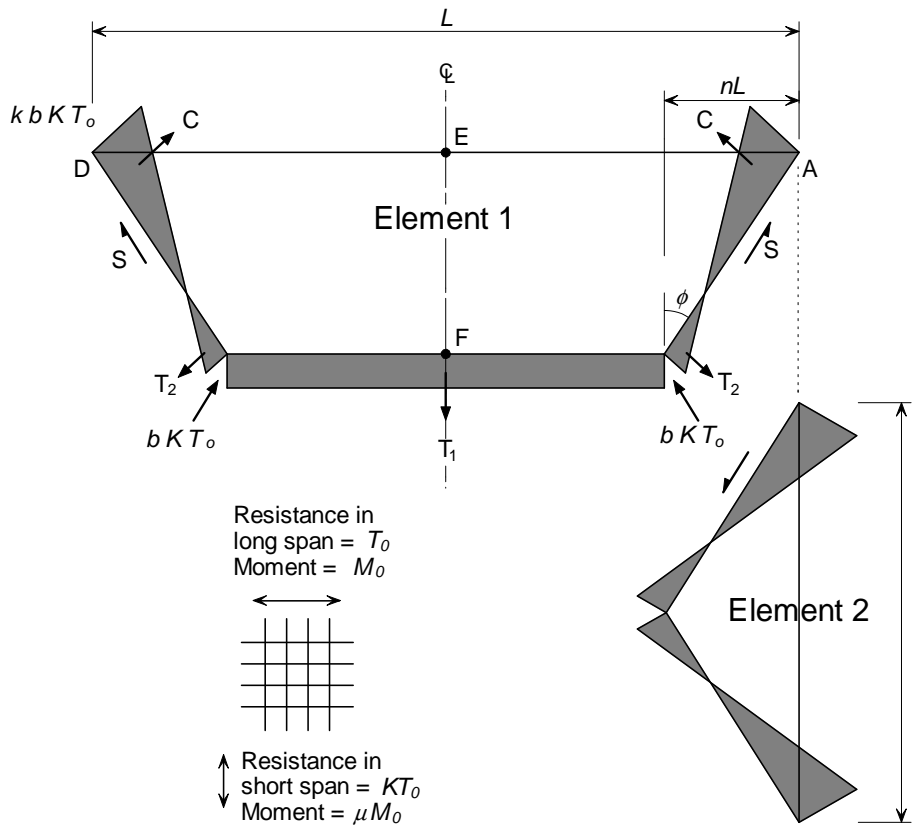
Distribución de tensión en plano para los elementos 1 y 2
